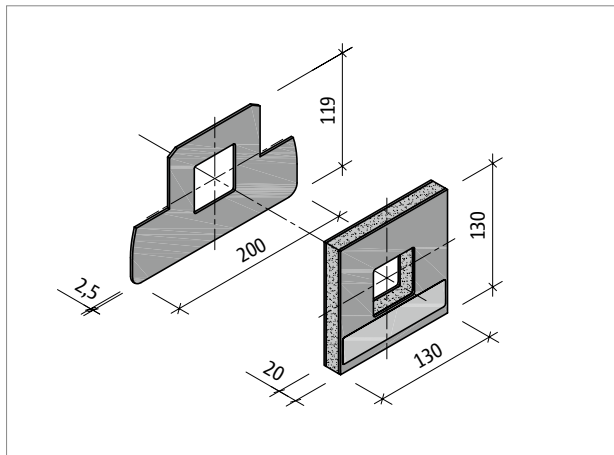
Schöck Tronsole® Typ P: Brandschutz-Set bestehend aus Brandschutzabdeckung ($t = 2,5$ mm) und Brandschutzmanschette(n)
